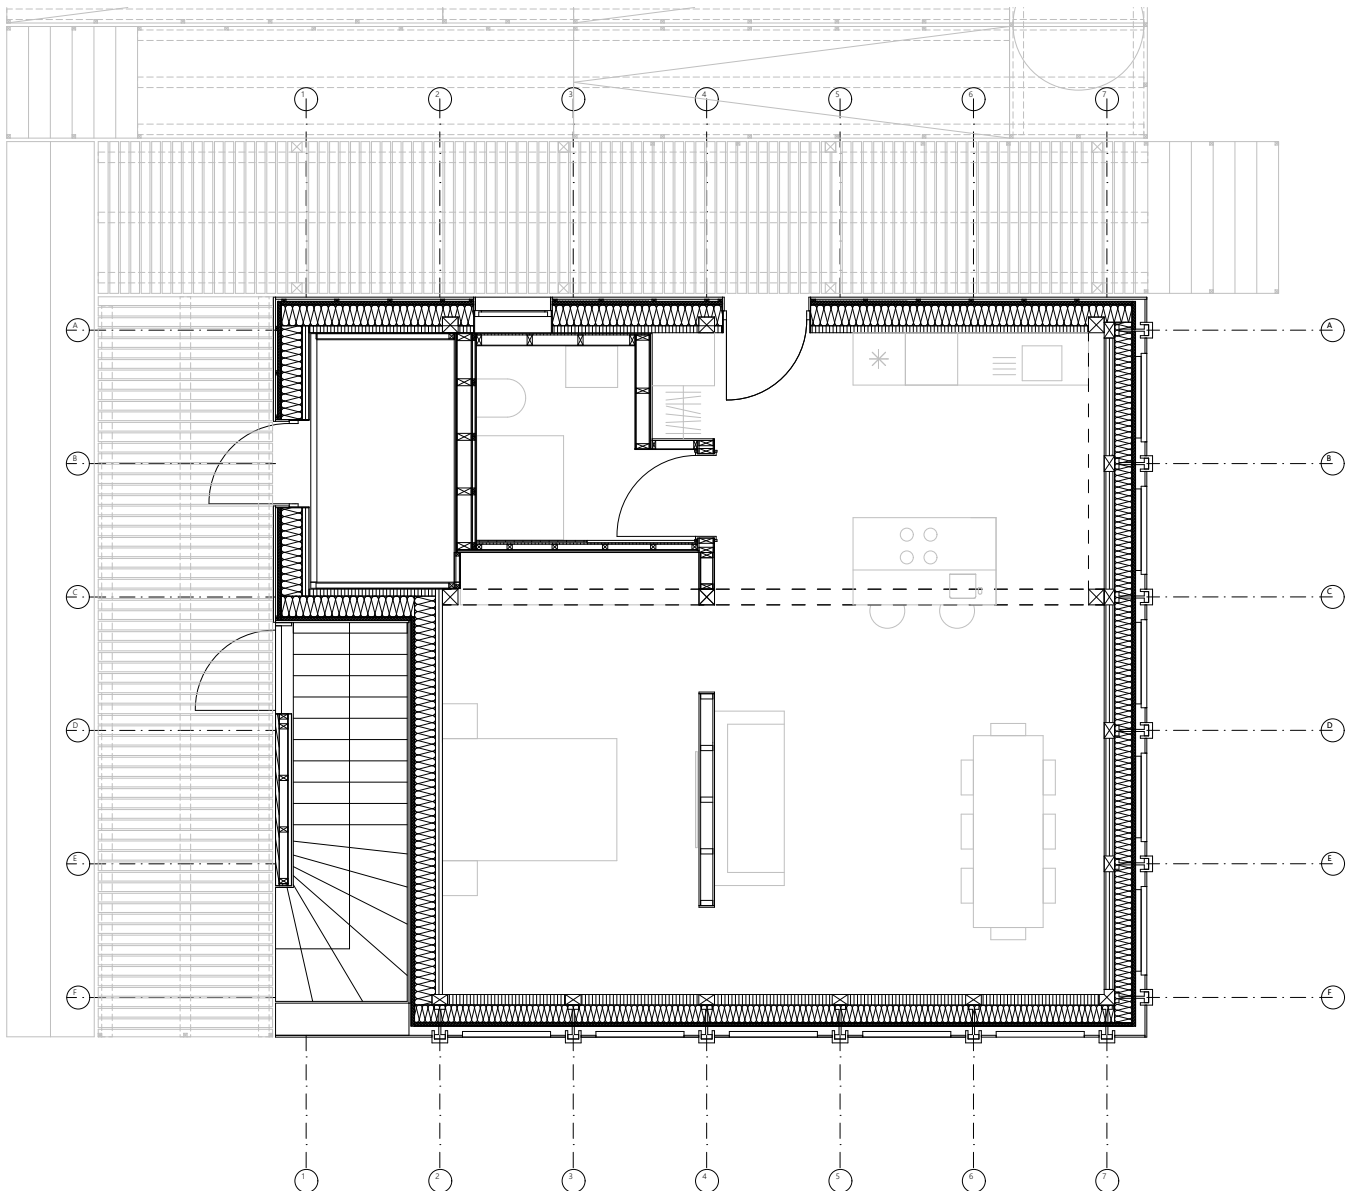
Grundriss HDU – Geometrische Differenzierung zwischen „dienender Schicht“ und Wohn- und Lebensraum
